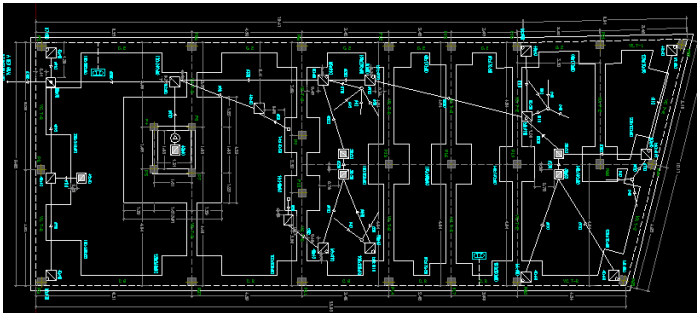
Obtenida del proyecto de ejecución. Planta de cimentación.
